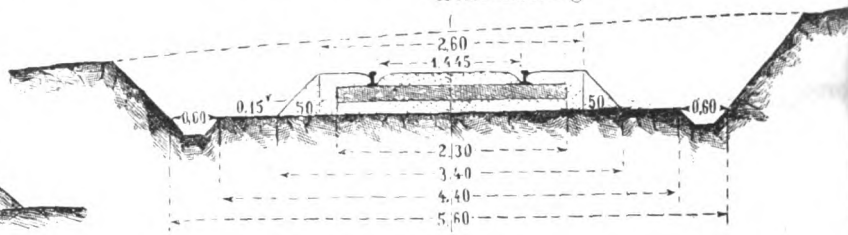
Billige Regelspur I mit Fahrzeugen der Hauptbahnen. Einschnitt mit freier Bettung.
